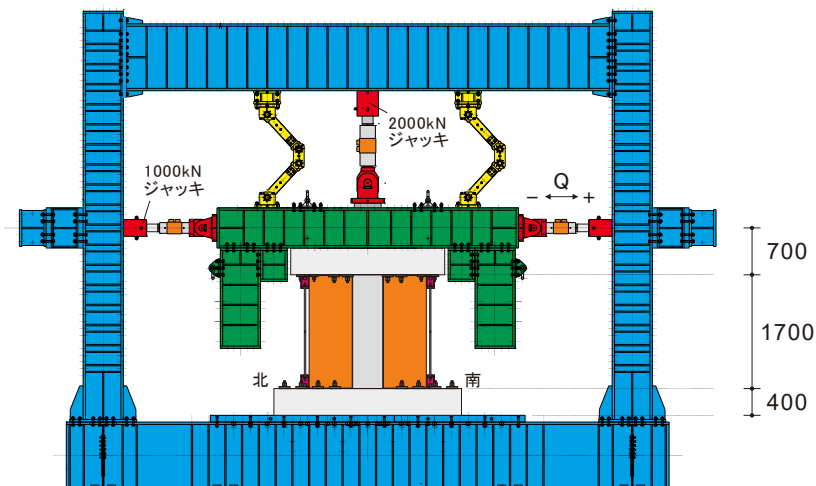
試験体 BS の加力装置図 (単位 : mm)
